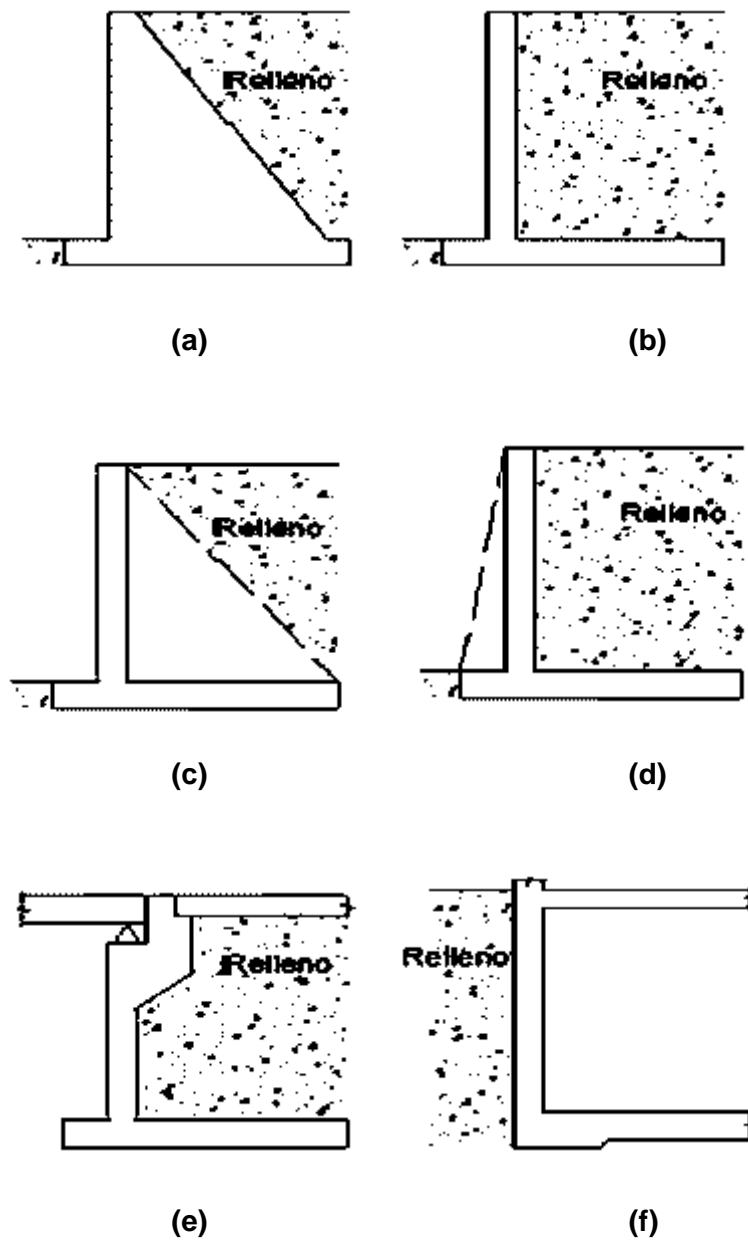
a) muros de gravedad, b) muros en voladizo, c) y d) muros con contrafuerte e) estribo de puente f) muro de sótano, Tipos de muros de contención.
